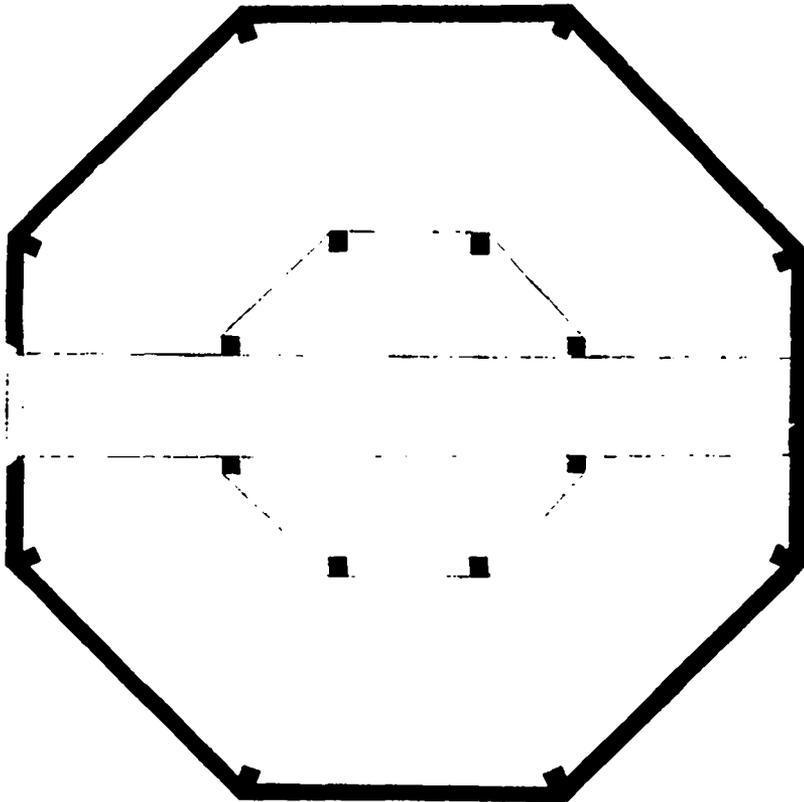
FIG. IV.—VUE EN PLAN, A LA HAUTEUR DES COMBLES.
